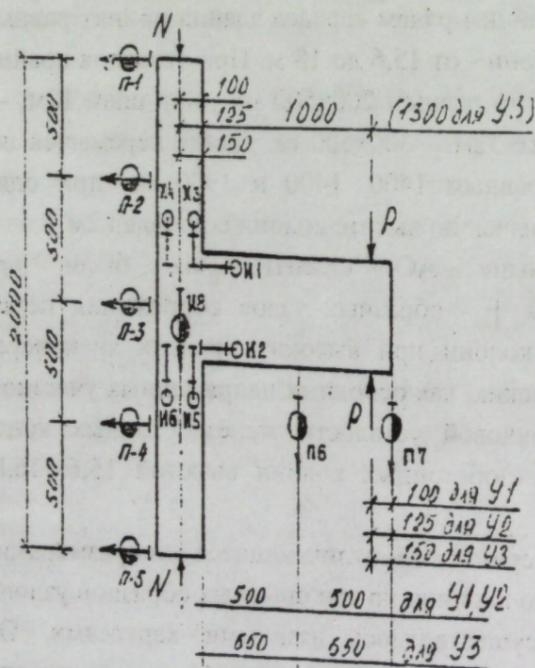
Схема и общий вид испытания узла на специальном стенде.
